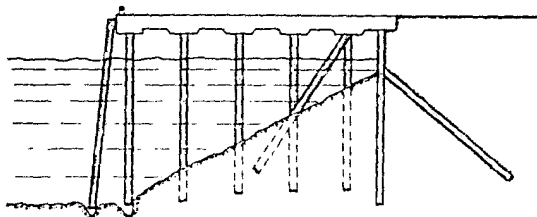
Construcción tipo abierto c/cubierta de nivel superior.
